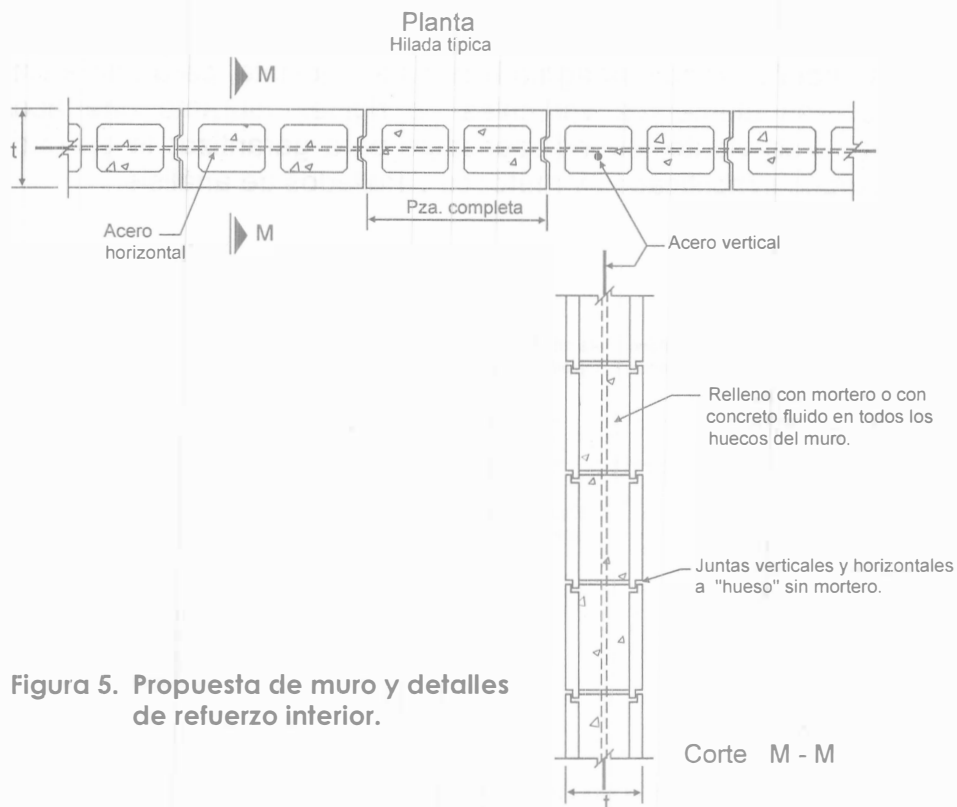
Propuesta de muro y detalles de refuerzo interior.
